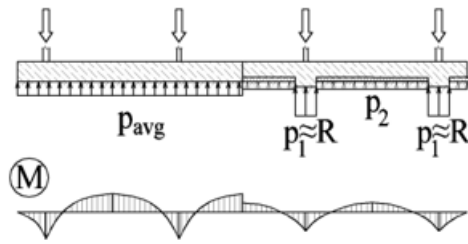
Плитний фундамент багатоповерхових будівель [1]
